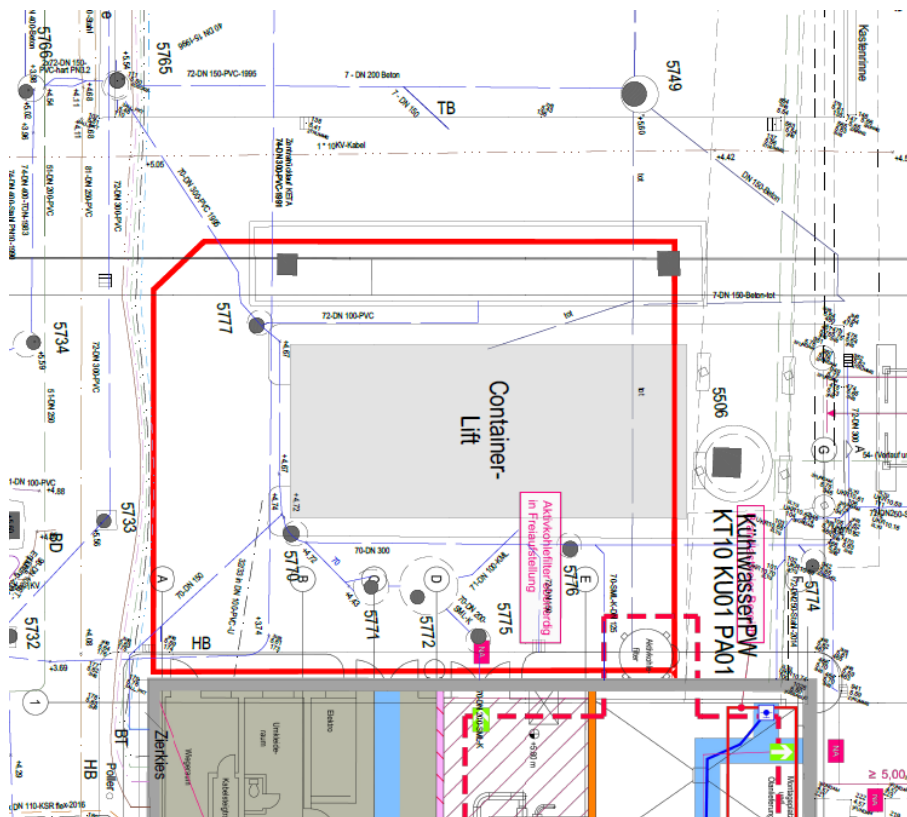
Ausschnitt Lageplan Köhlbrandhöft, Grundriss Neubau Werkstatt (rot markiert)
